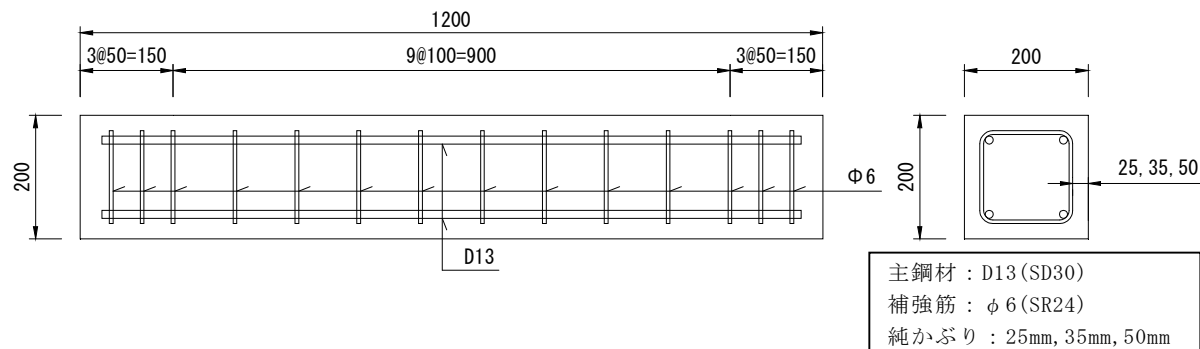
試験体形状（鉄筋コンクリート小型試験体）
